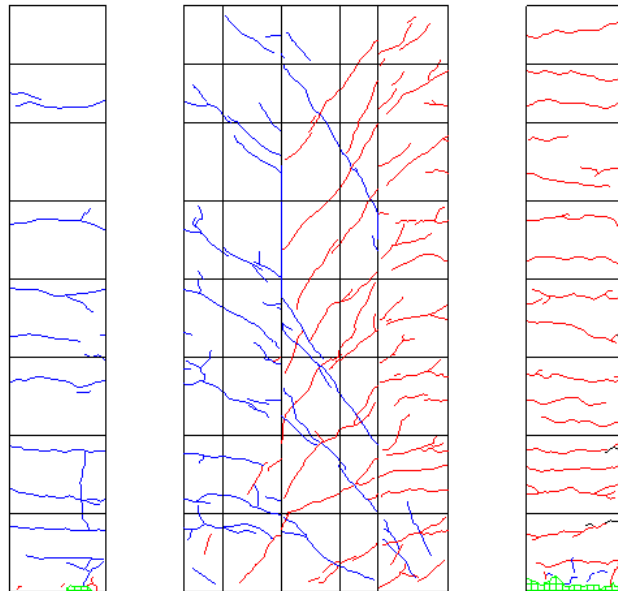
R=-1/50 ひび割れ図
